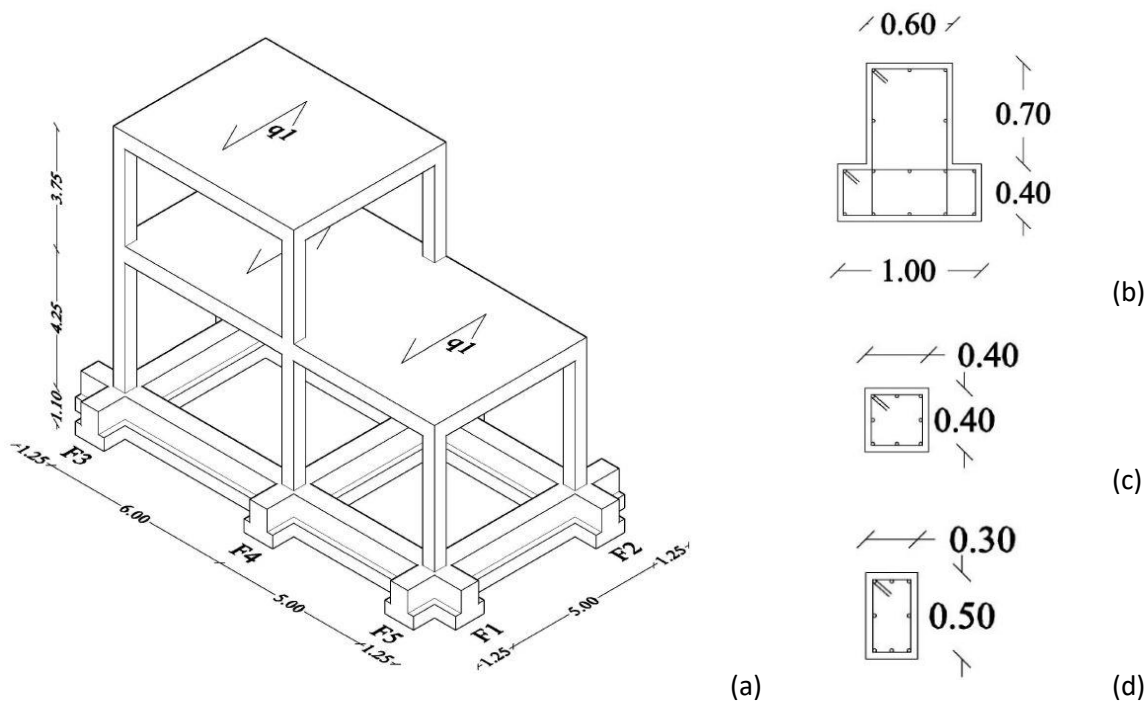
Telaio tridimensionale (in m) e carichi applicati (a); sezione trasversale trave di fondazione (b), colonne (c) e travi in elevazione (d).
